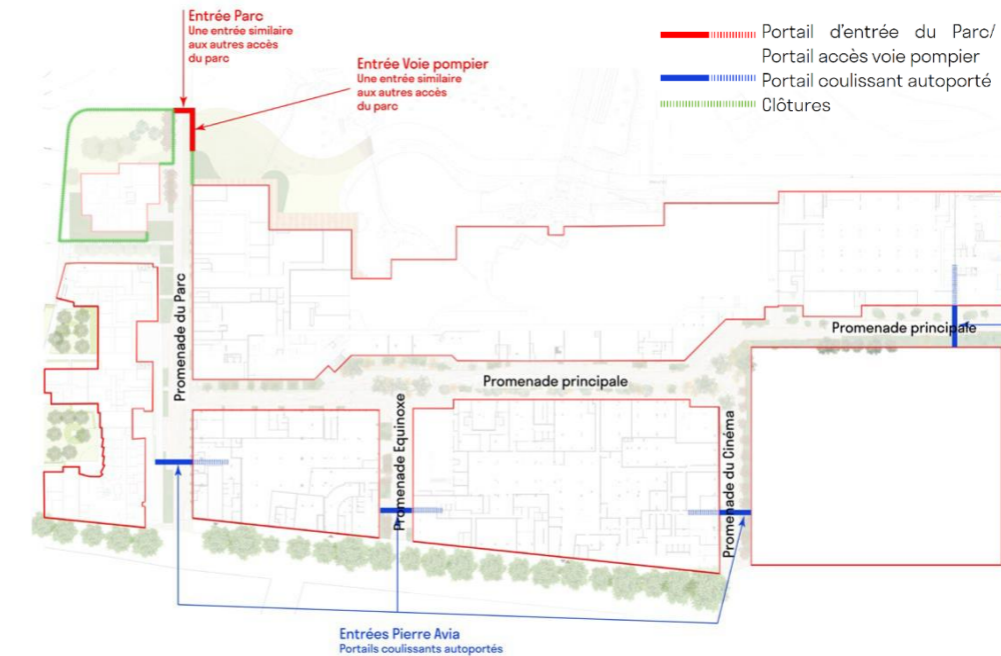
Plan des clôtures et des portails d'accès au site (Source : Leclercq Associés)
